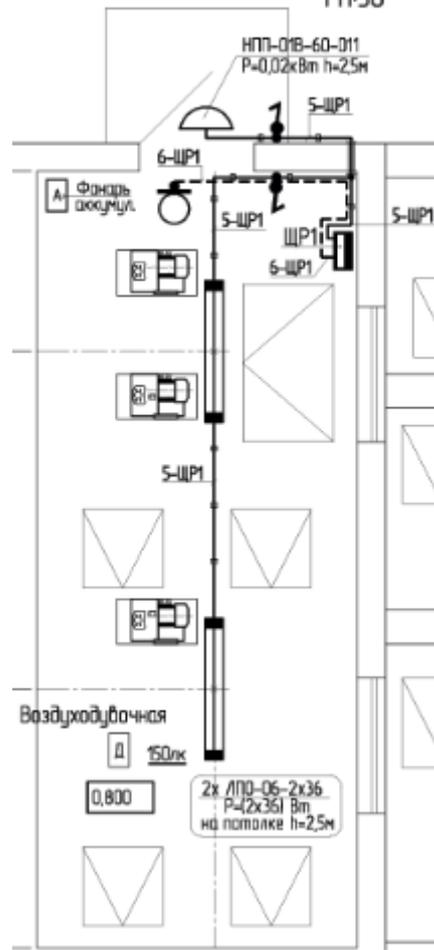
Схема электроснабжения ОС д.Бершово
